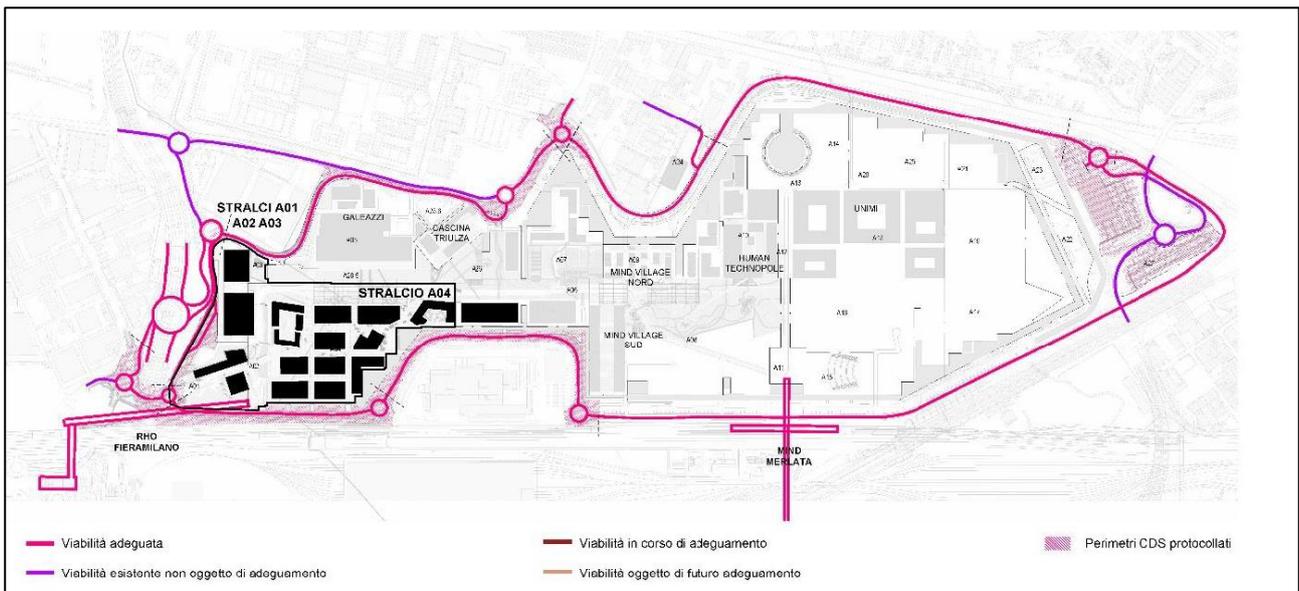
Planimetria di MIND all'orizzonte T6 (fonte STUDIO MIND)
